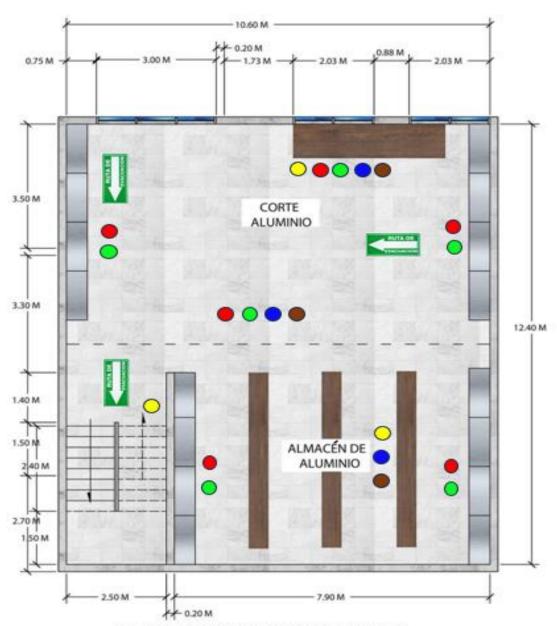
Mapa de riesgos Planta Arquitectónica Nivel 2
